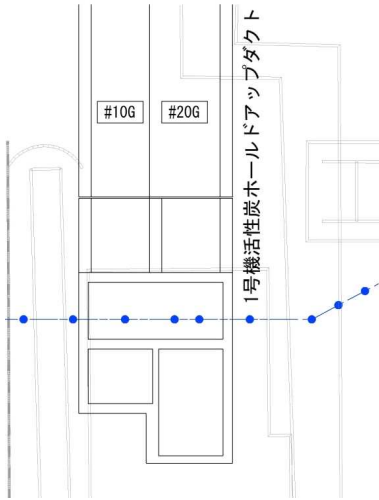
【5-2】2号機主変圧器ケーブルダクト 施工方法（貫通施工）
